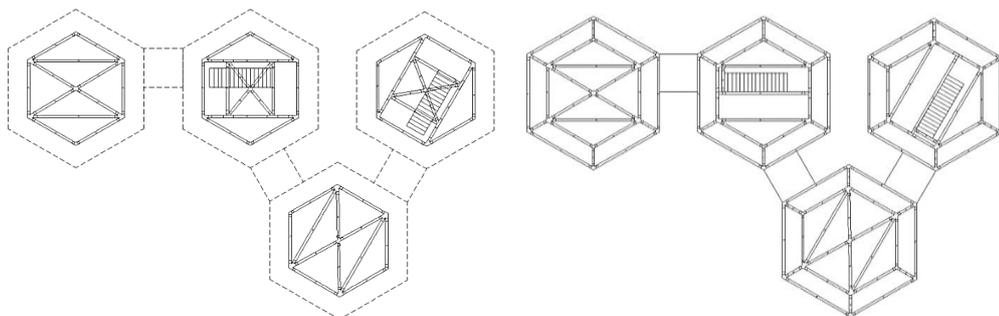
Sistema estructural de vigas principales en primer y segundo nivel.
